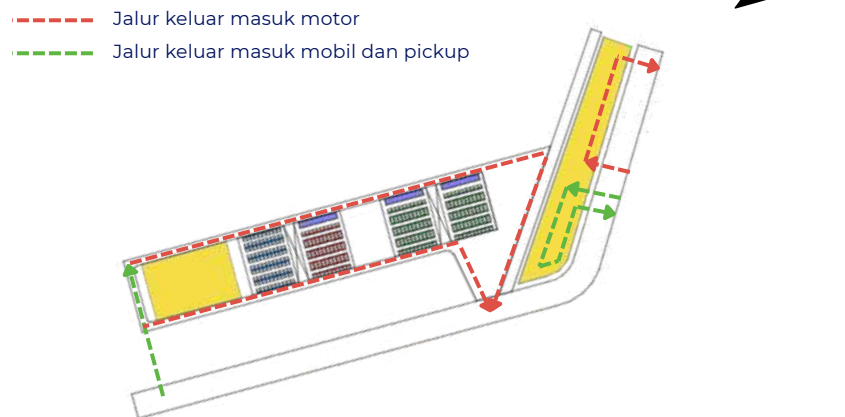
Alternatif Gubahan Massa Terpilih
